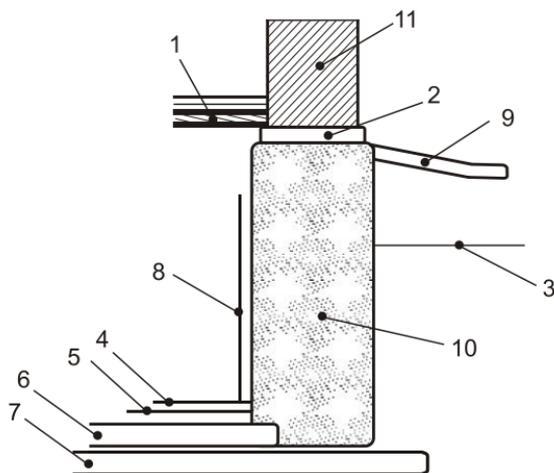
Устройство гидроизоляции с использованием цемента «Гидро-S»: 1 — перекрытие; 2 — горизонтальная гидроизоляция; 3 — уровень грунтовых вод; 4 — чистый пол подвала; 5 — цементная стяжка; 6 — железобетонная плита; 7 — монолитный бетон (подготовка); 8 — вертикальная гидроизоляция; 9 — отмостка; 10 — фундамент; 11 — стена
